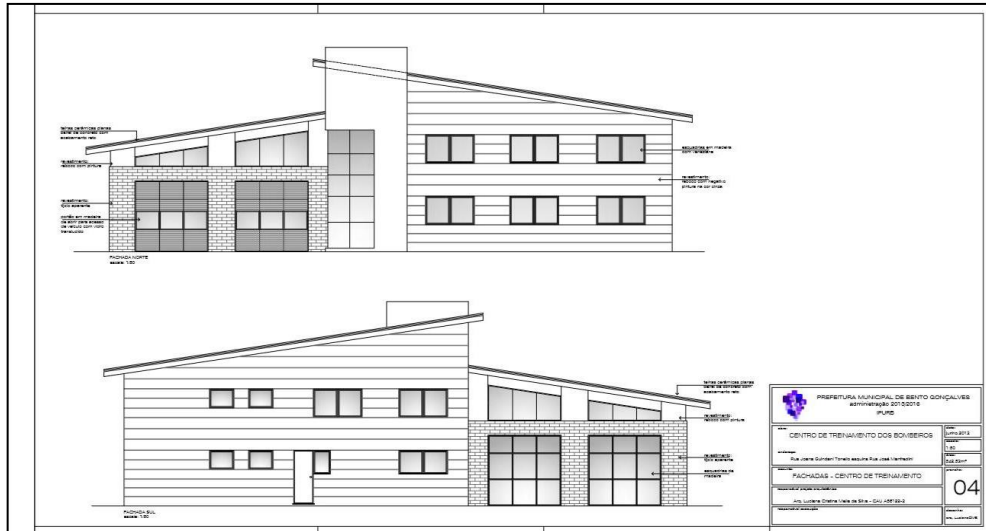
Projeto para a construção do Centro de Treinamento de Bento Gonçalves.
